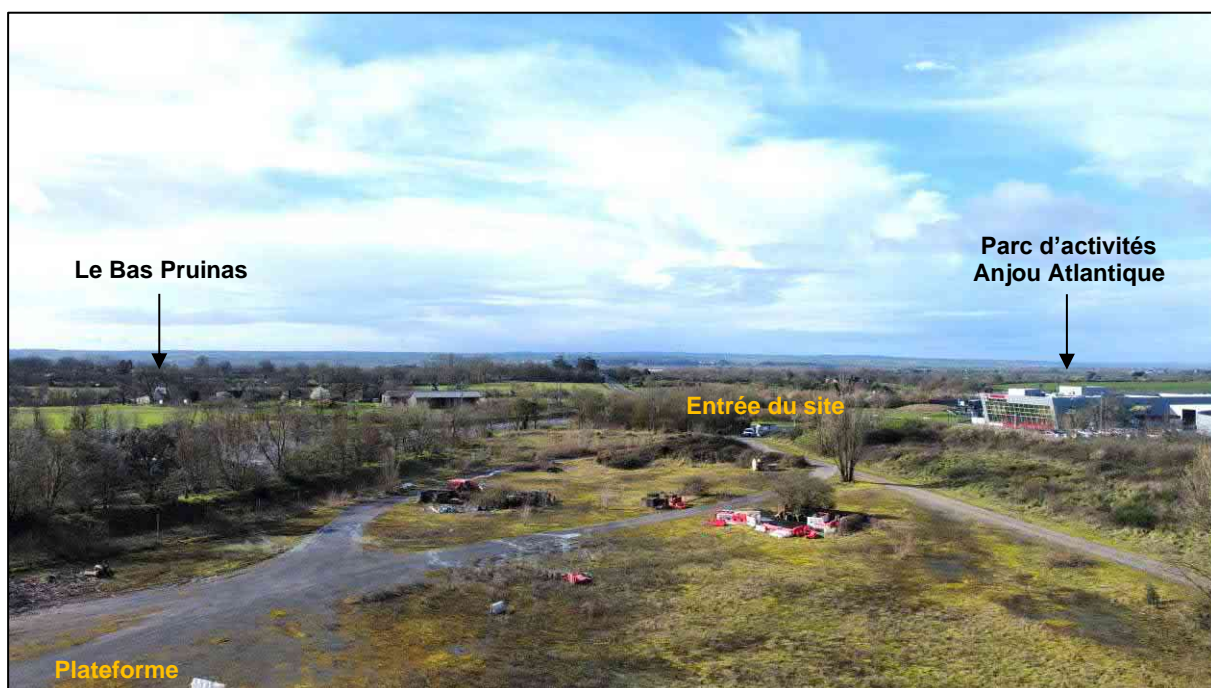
Vue à 13 m de hauteur vers le sud de la plateforme
